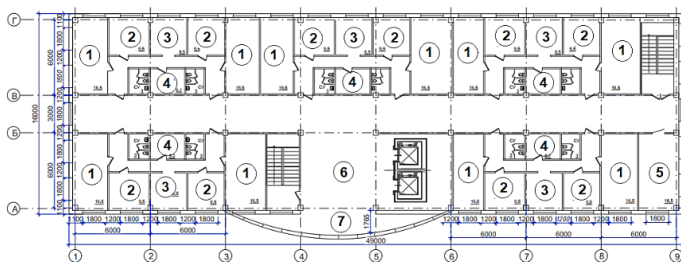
План 2–6-го этажей студенческого общежития:
